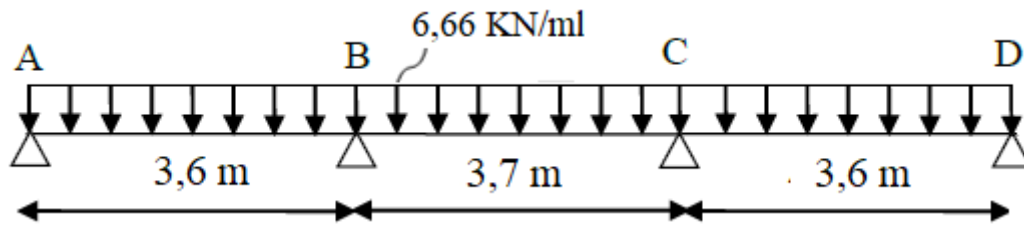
Types de poutrelles dans le plancher pour exemple de calcul.
